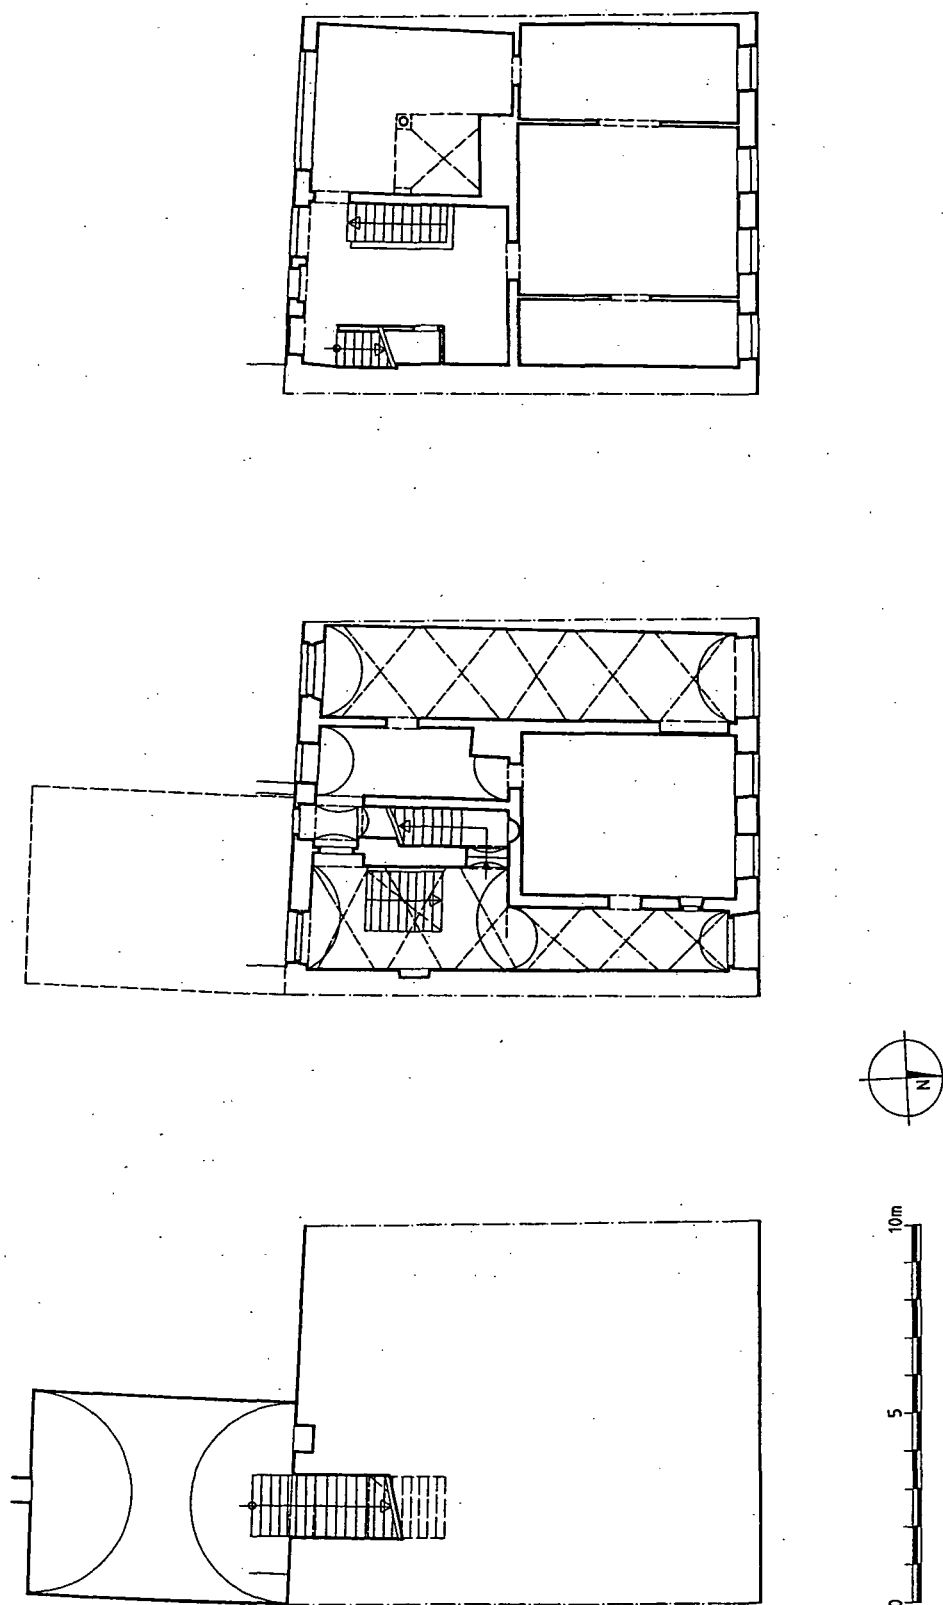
Schmiedstraße 21 – Grundrisse Keller, Erdgeschoss, Obergeschoss (1:200).
